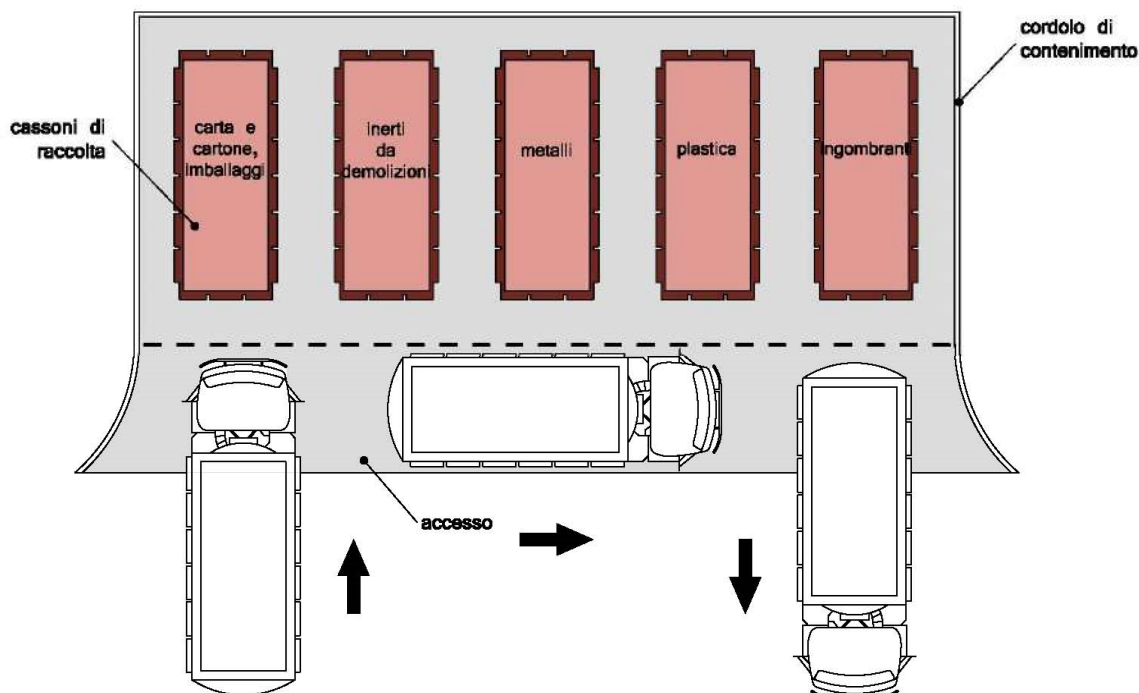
Esempio di area attrezzata per la raccolta dei rifiuti all'interno del cantiere fisso.
